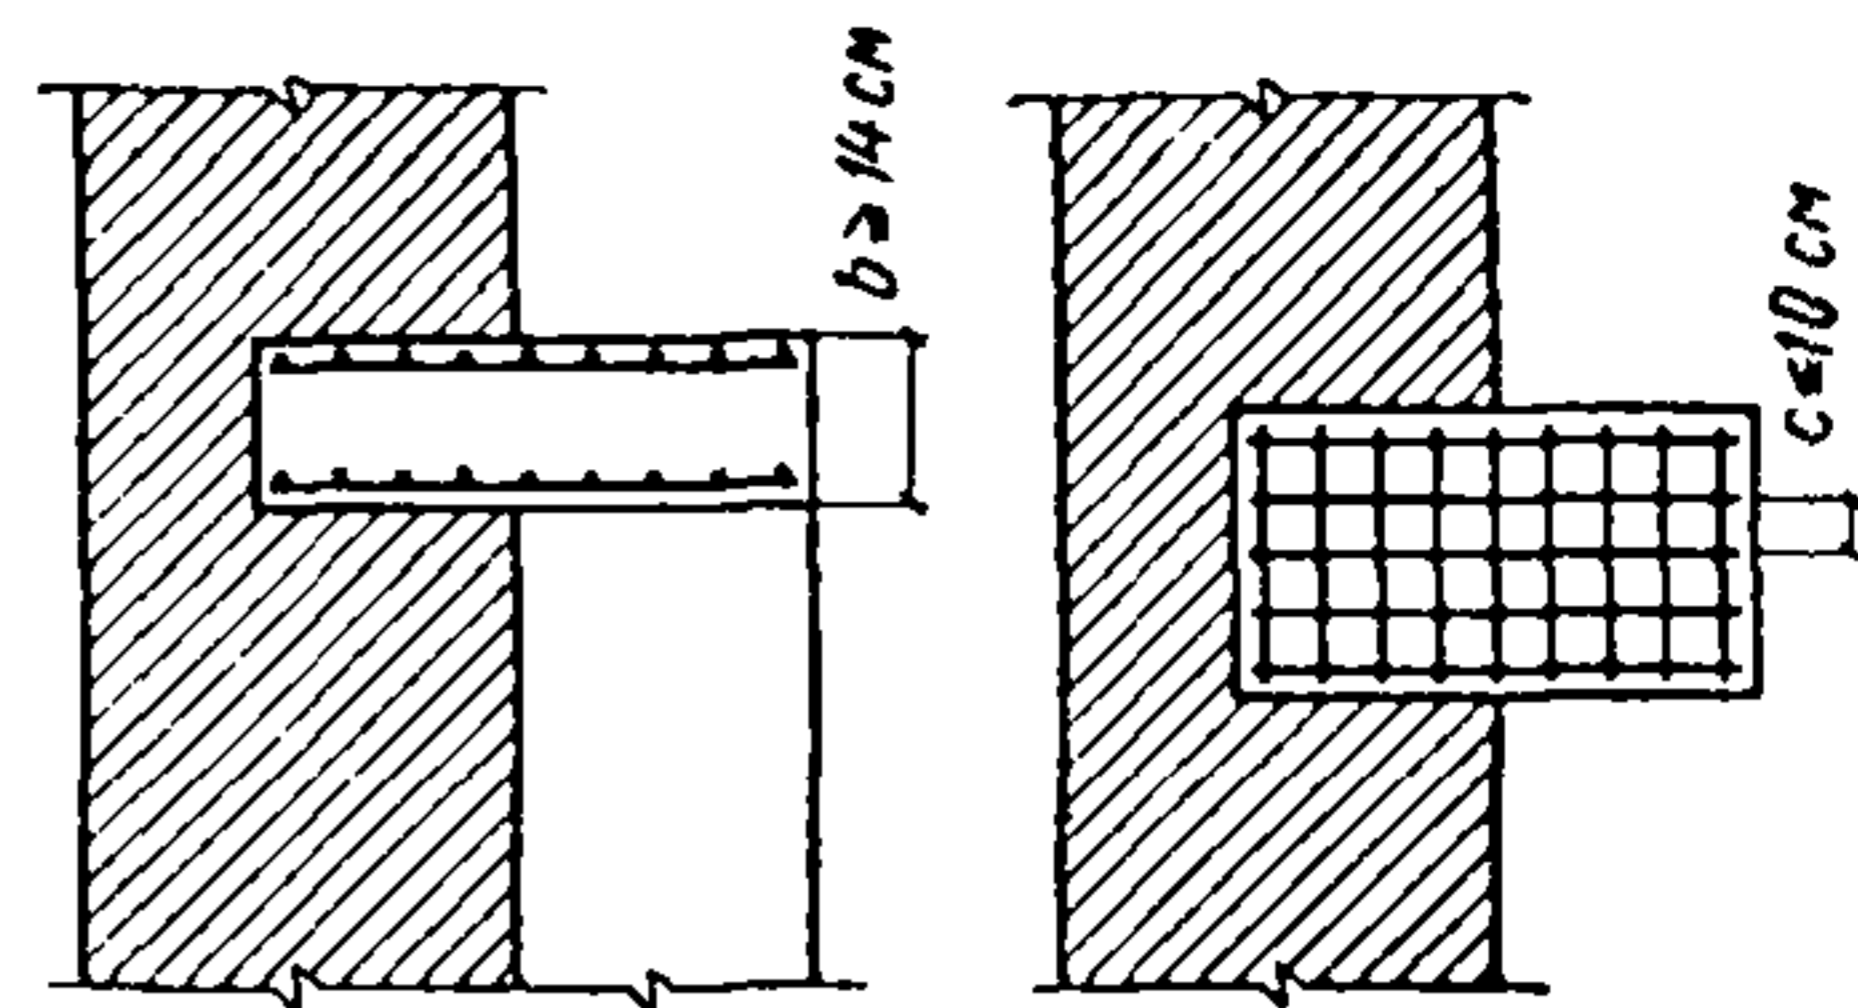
Схема установки и армирования железобетонной опорной плиты
